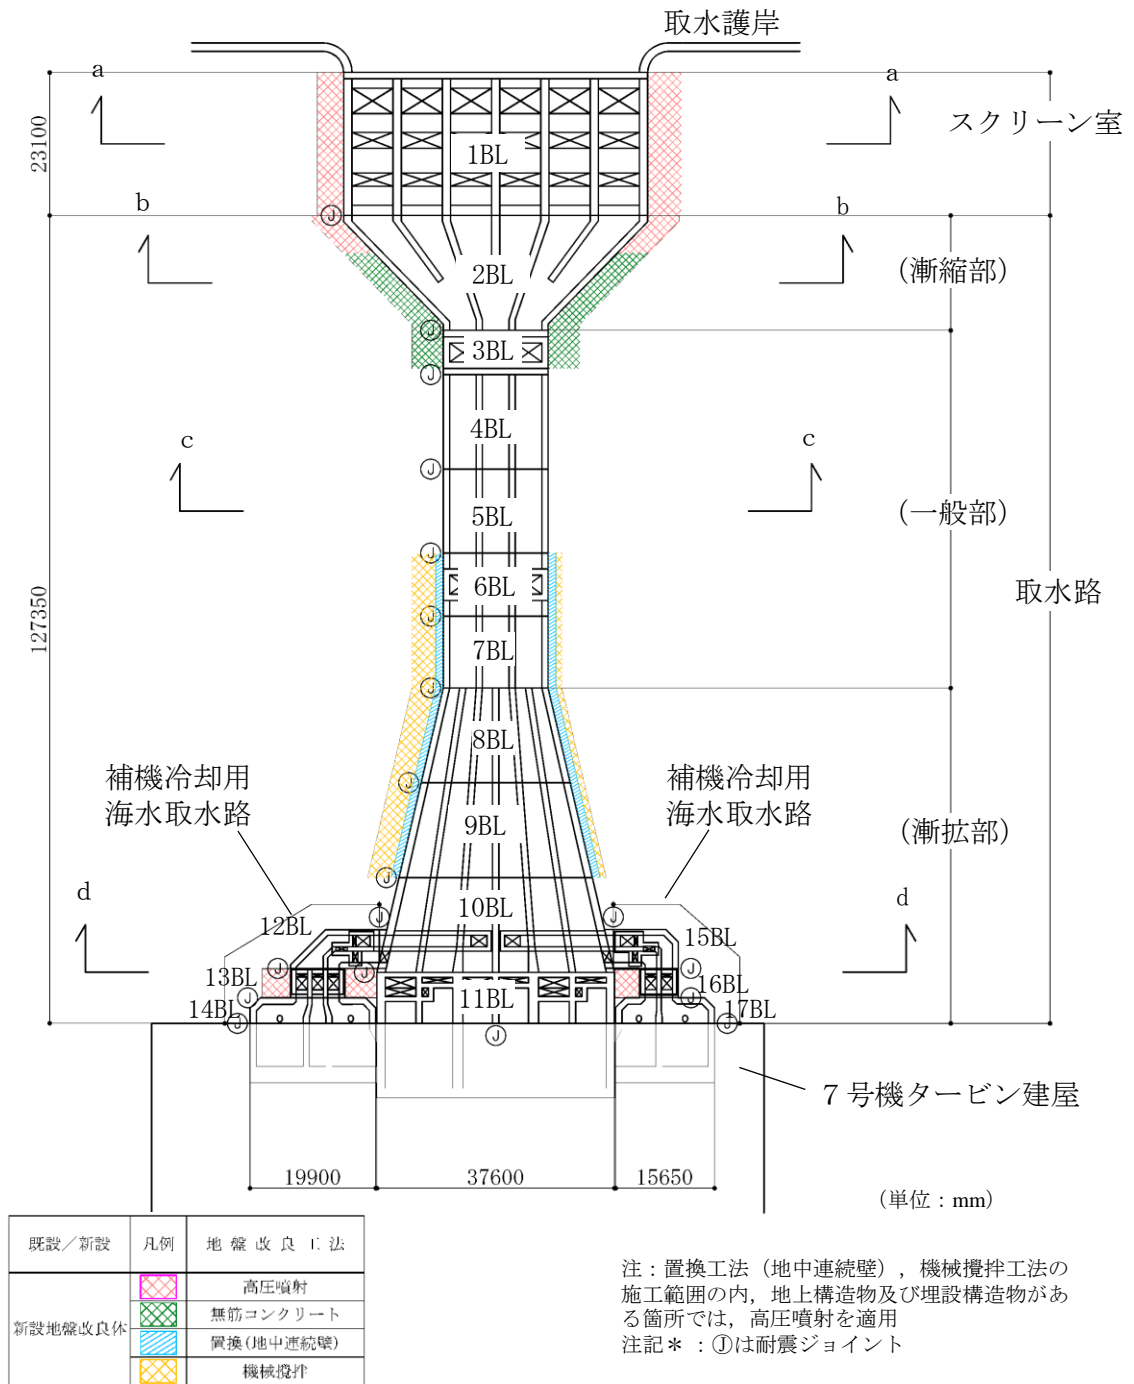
スクリーン室，取水路及び補機冷却用海水取水路の平面図
